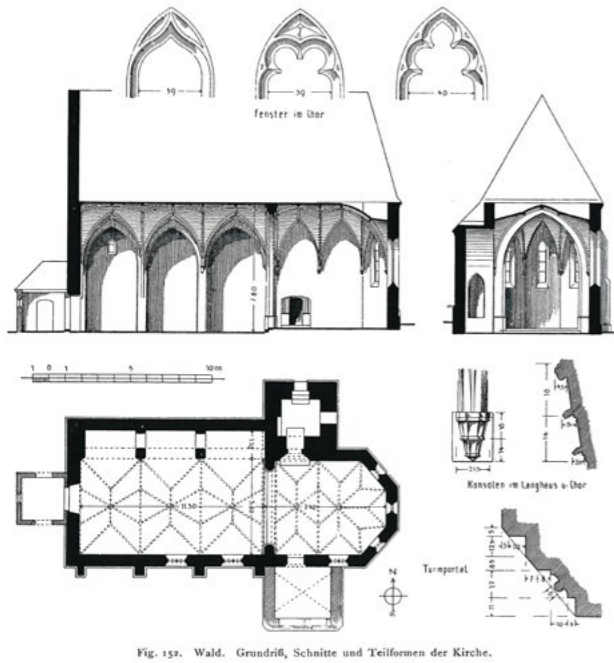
Wald. Grundriß, Schnitte und Teilformen der Kirche.
